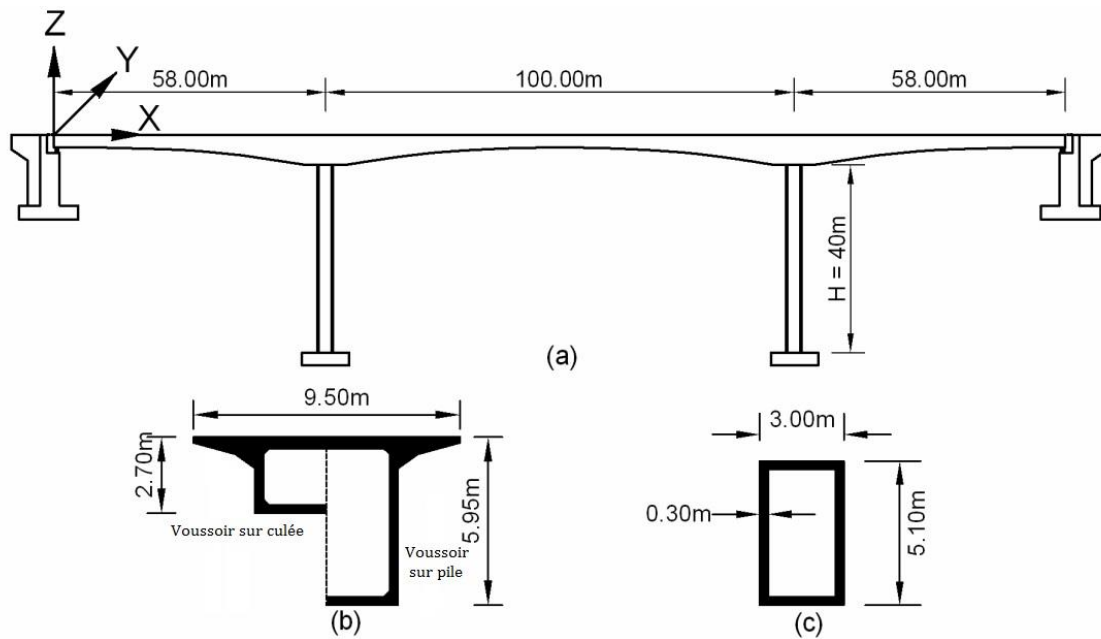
Description du pont de mascara : (a) Vue générale (b) Section transversales de voussoirs (c) Section des piles
